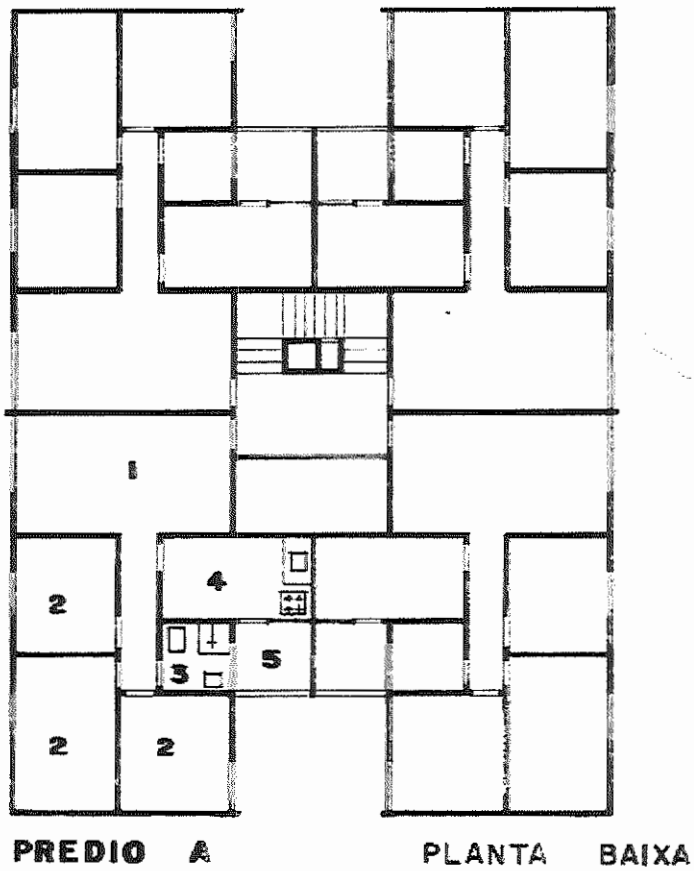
Plantas das unidades habitacionais de dois pavimentos
